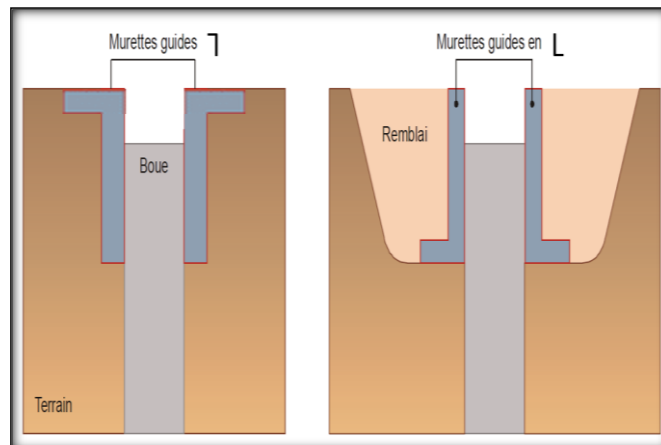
Schéma explicatif de construction de murettes guidées
